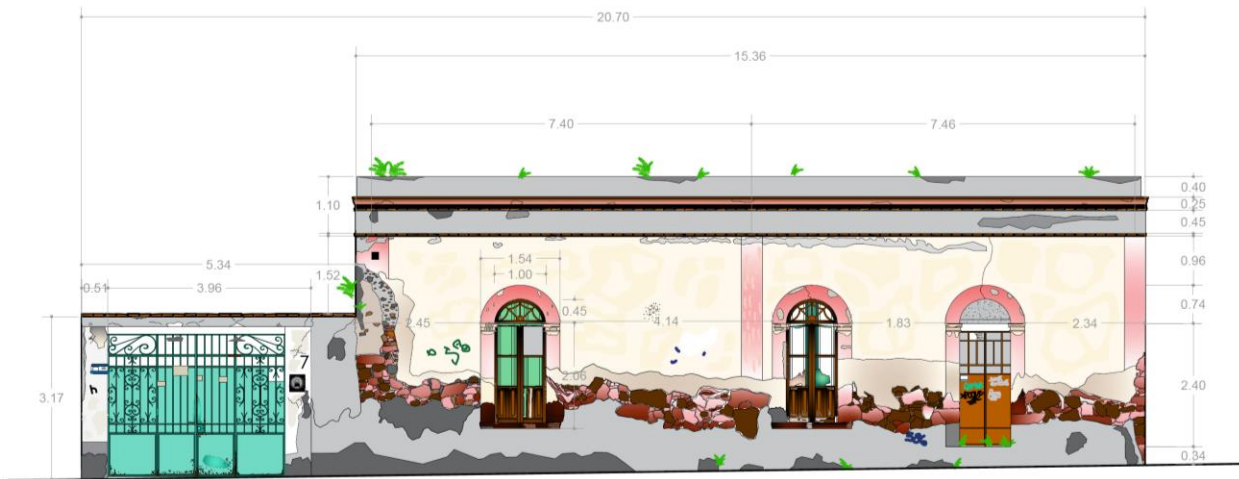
Fachada norponiente, sin escala. Elaboración propia
